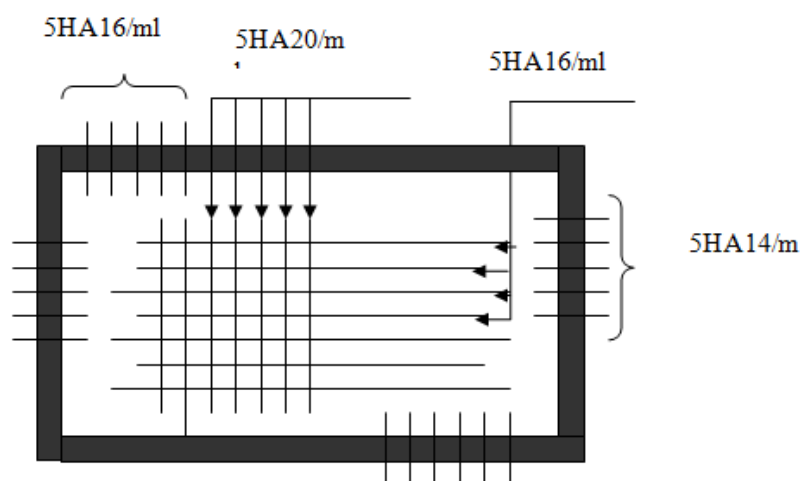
Schéma de ferrailage de la dalle de radier
